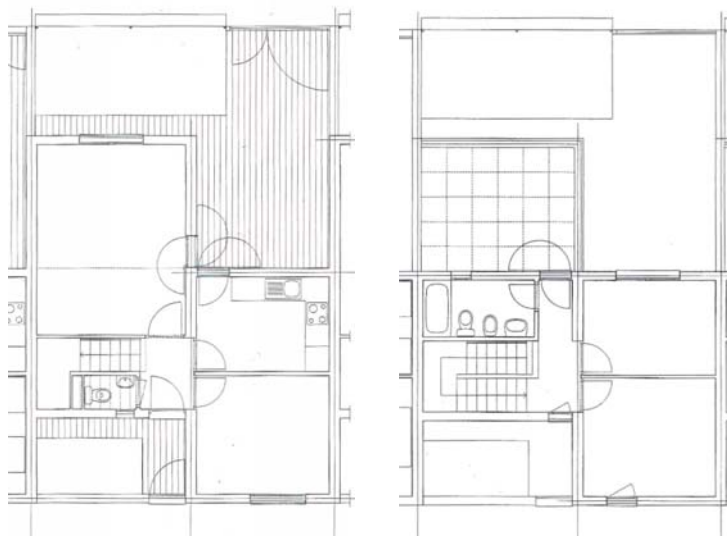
Blanca Sánchez Lara. 20 Viviendas autoconstruidas en Lantejuela, Sevilla. Plantas baja y primera
